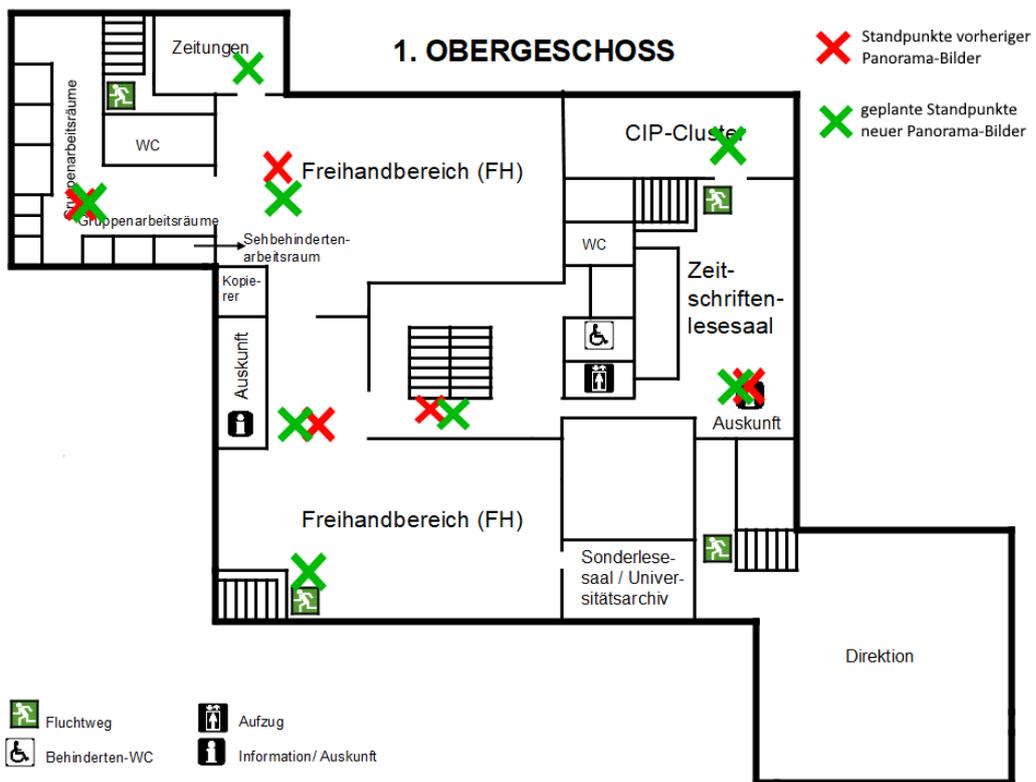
Grundriss 1. Obergeschoss UB Gießen
